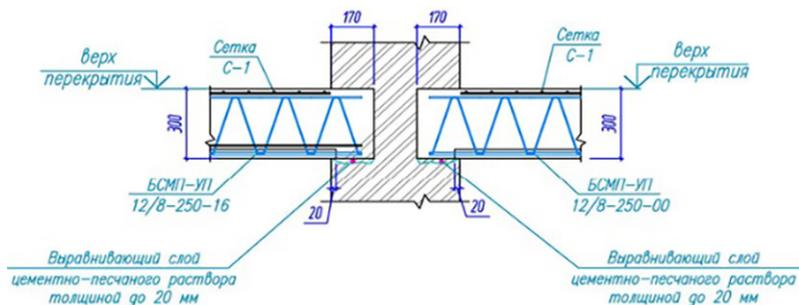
Узел примыкания балок СМП «МАРКО» к несущим стенам ГБОУ СОШ № 514
